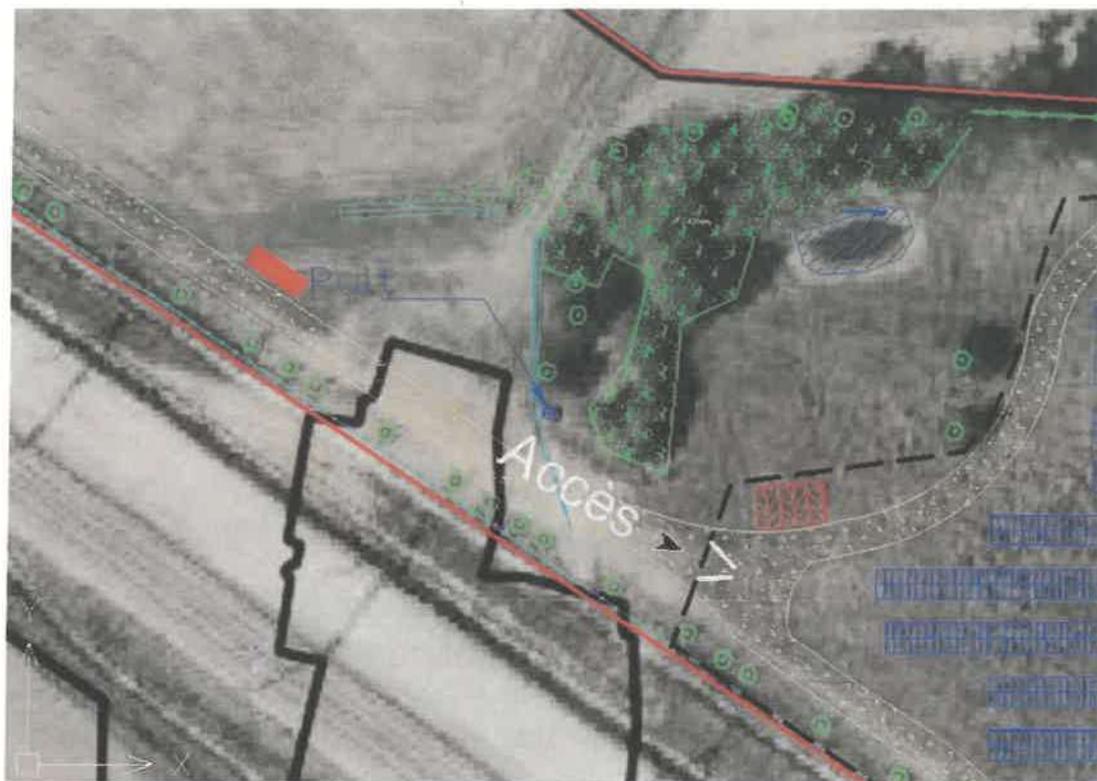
Localisation de l'ouvrage en pierre (Puits) sur le site.
